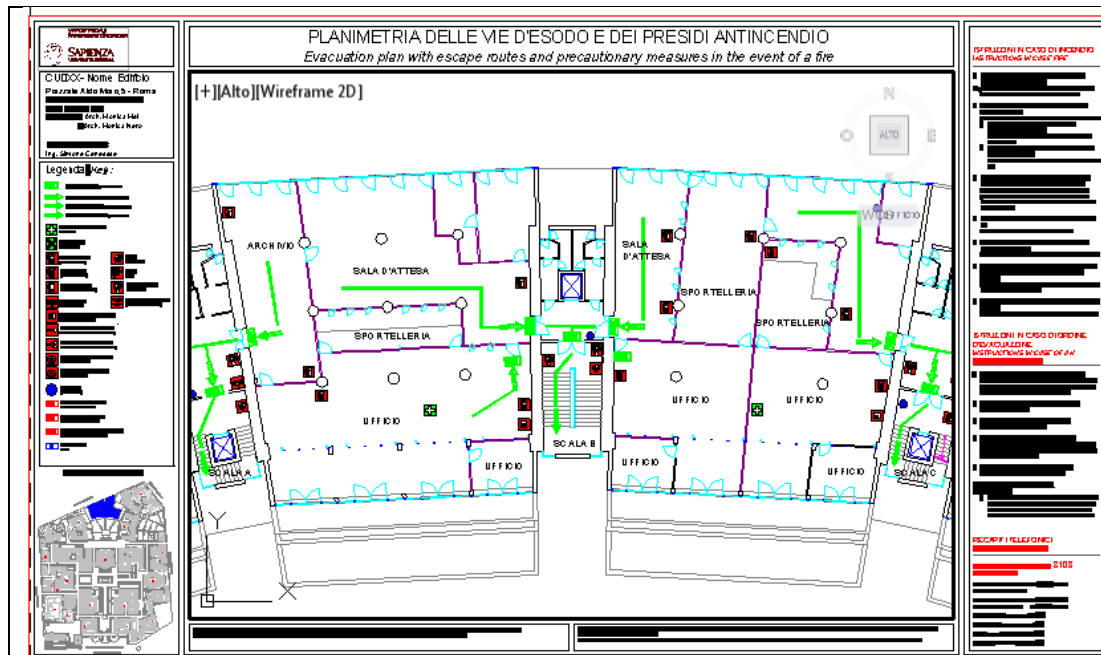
Esempio di Planimetria riportante le Vie di Fuga
